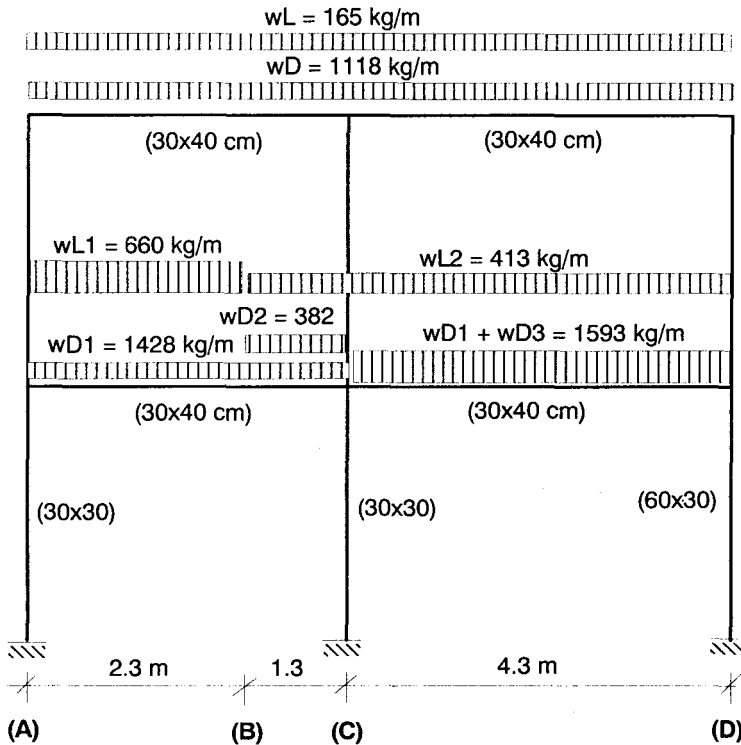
Cargas Actuantes en las Vigas del Eje 1.
